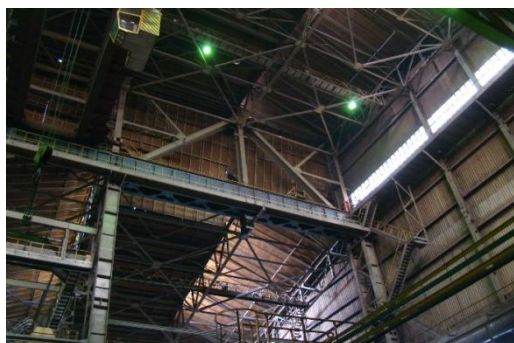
Подкраново-подстропильная ферма по ряду Б, оси 14' – 16'
